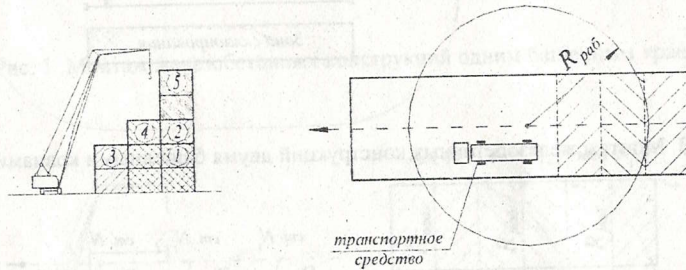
Монтаж конструкций башенным краном, расположенным в пределах поперечного сечения здания (для разрезки колонн по высоте 2эт.+1эт.+1эт.+1эт.)
